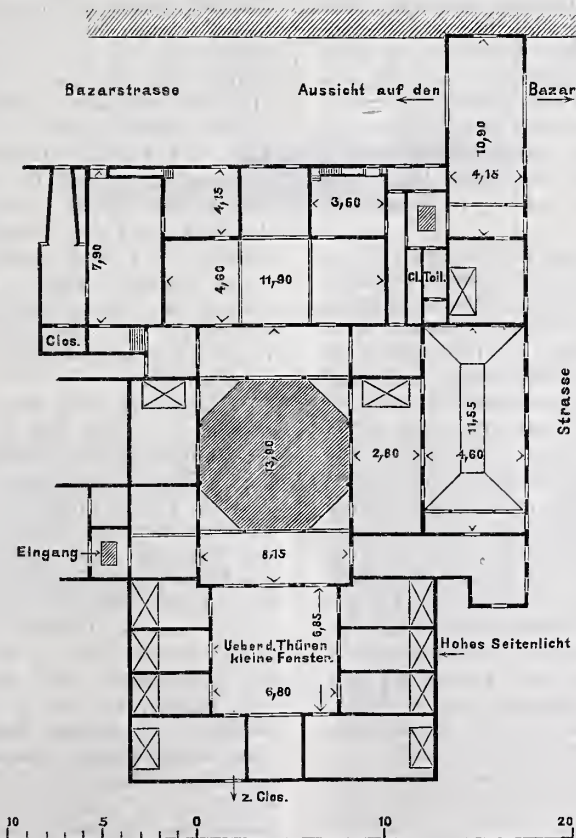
Grundriss des Dâr el Bey in Tunis.
